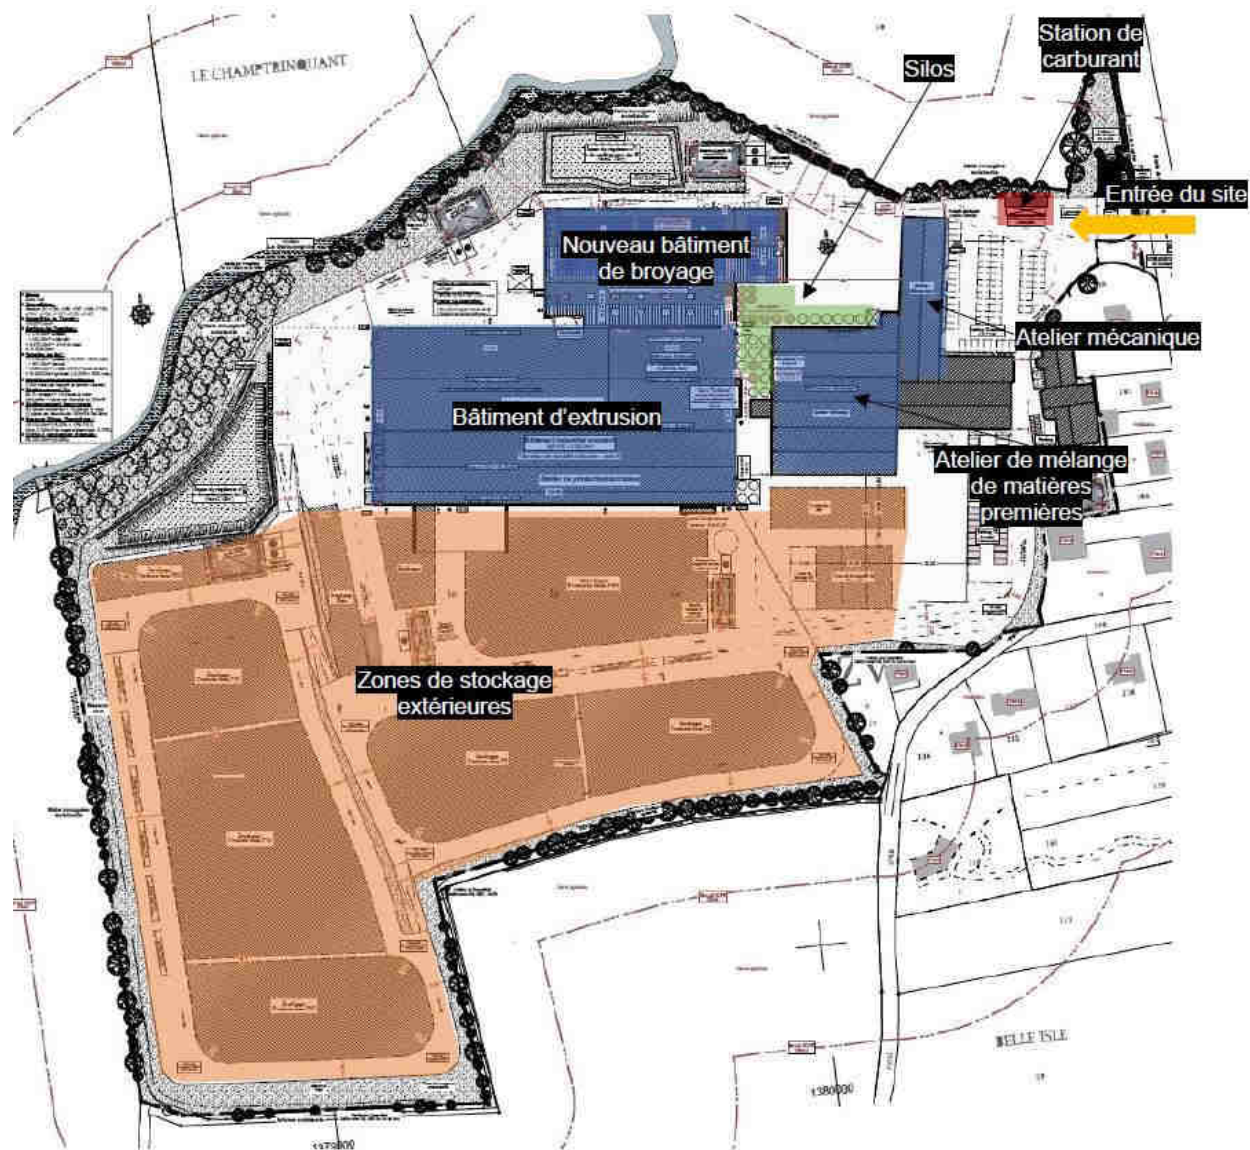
Plan masse du projet (Source : Nicot Architecte)
